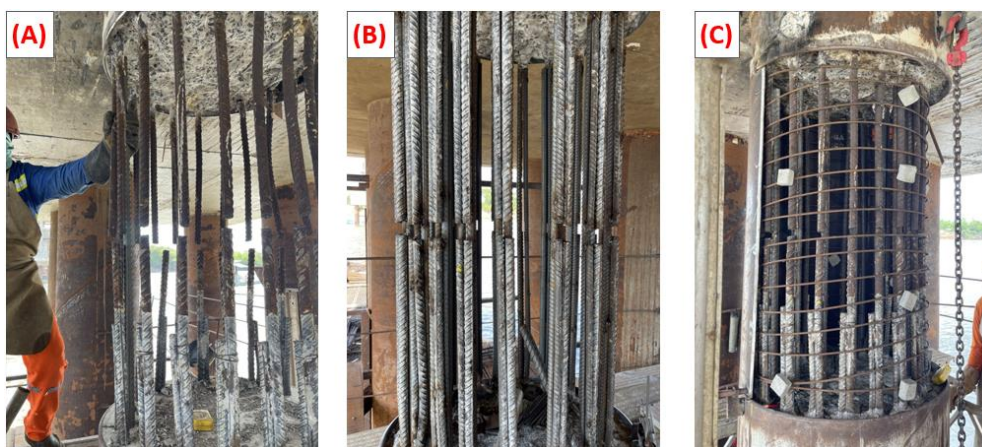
(A) Barras longitudinais retornadas à suas posições originais; (B) à barras de traspasse já soldadas, reconstituindo a armação e (C) estribagem refeita, com espaçadores de cobrimento.
